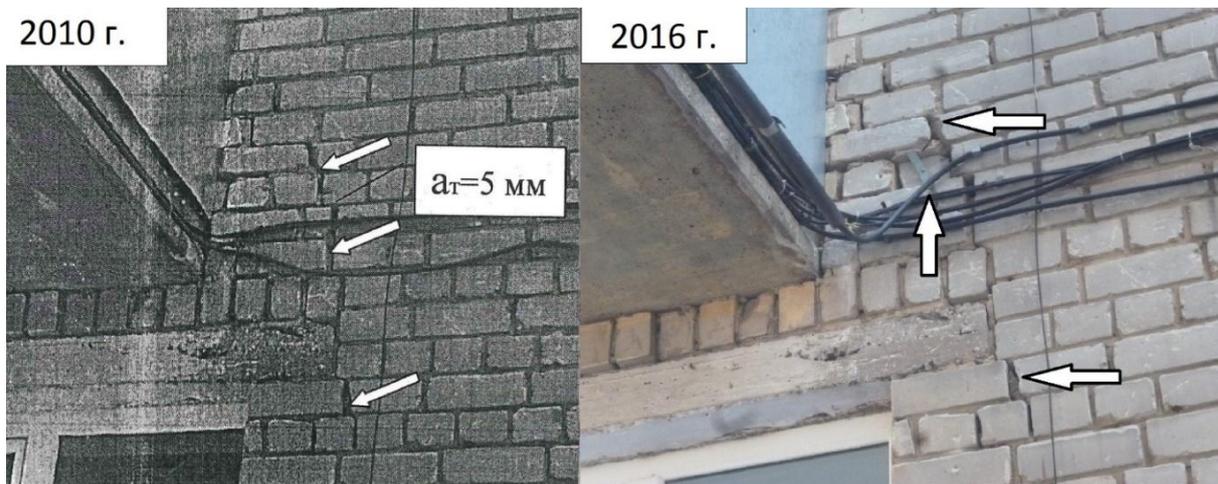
Трещина по шву кирпичной кладки на уровне перемычки оконного проема первого этажа западного торца здания.
